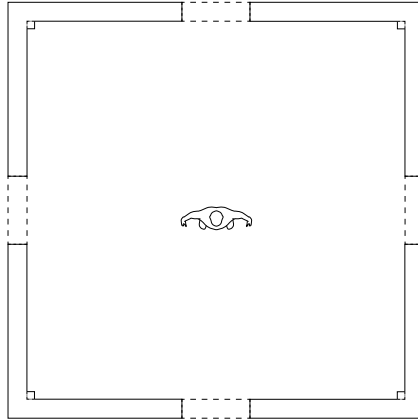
Pos. I.II | Grundriss – M.1:100
